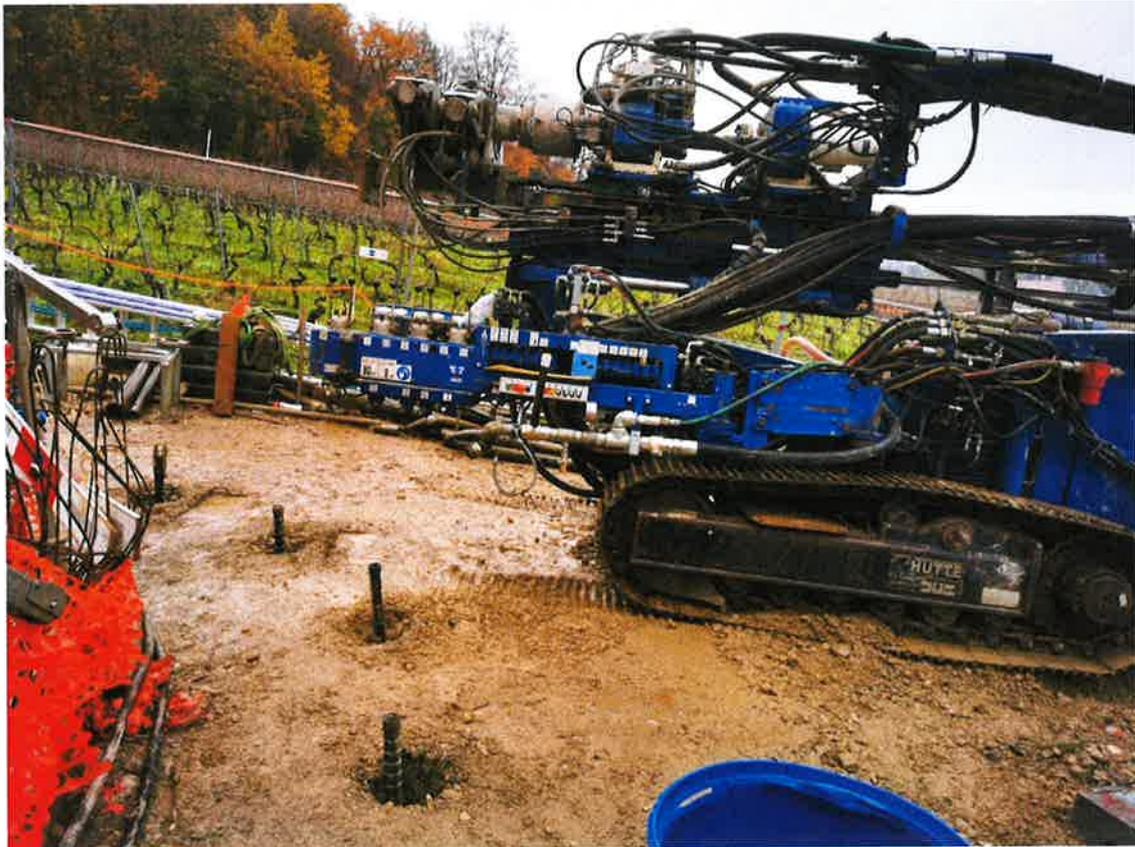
Installation des pipettes pour l'injection de la bentonite
